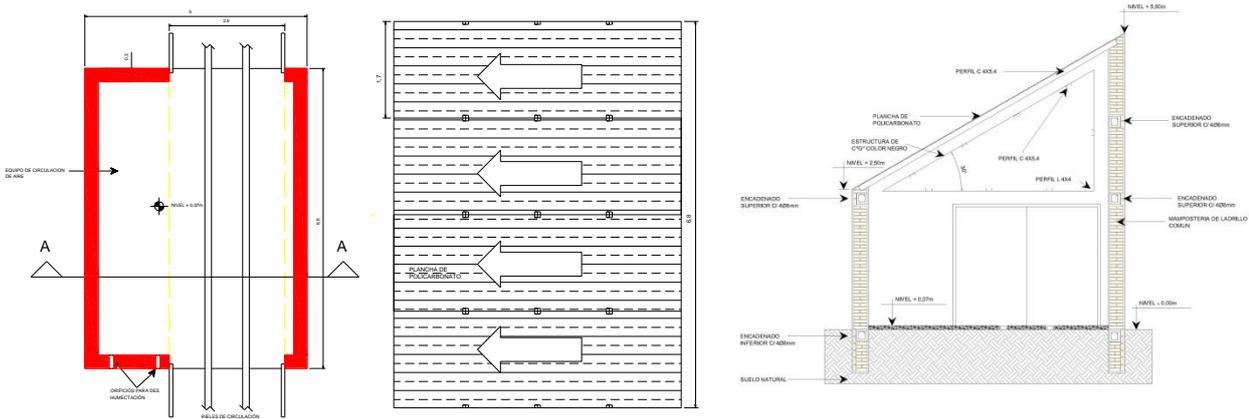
primer prototipo: planta general (izq.), planta de techo (centro) y corte (der.).
